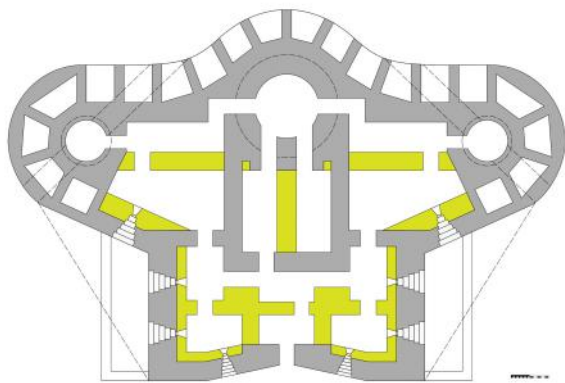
Grundriss nach Aufmaß in Neuhammer, Jüterbog und Döberitz mit den tatsächlich in (Schütt-)Beton ausgeführten Wänden (grau) und den aus Holzwolle-Leichtbauplatten (Heraklit) gebauten Bereichen.
